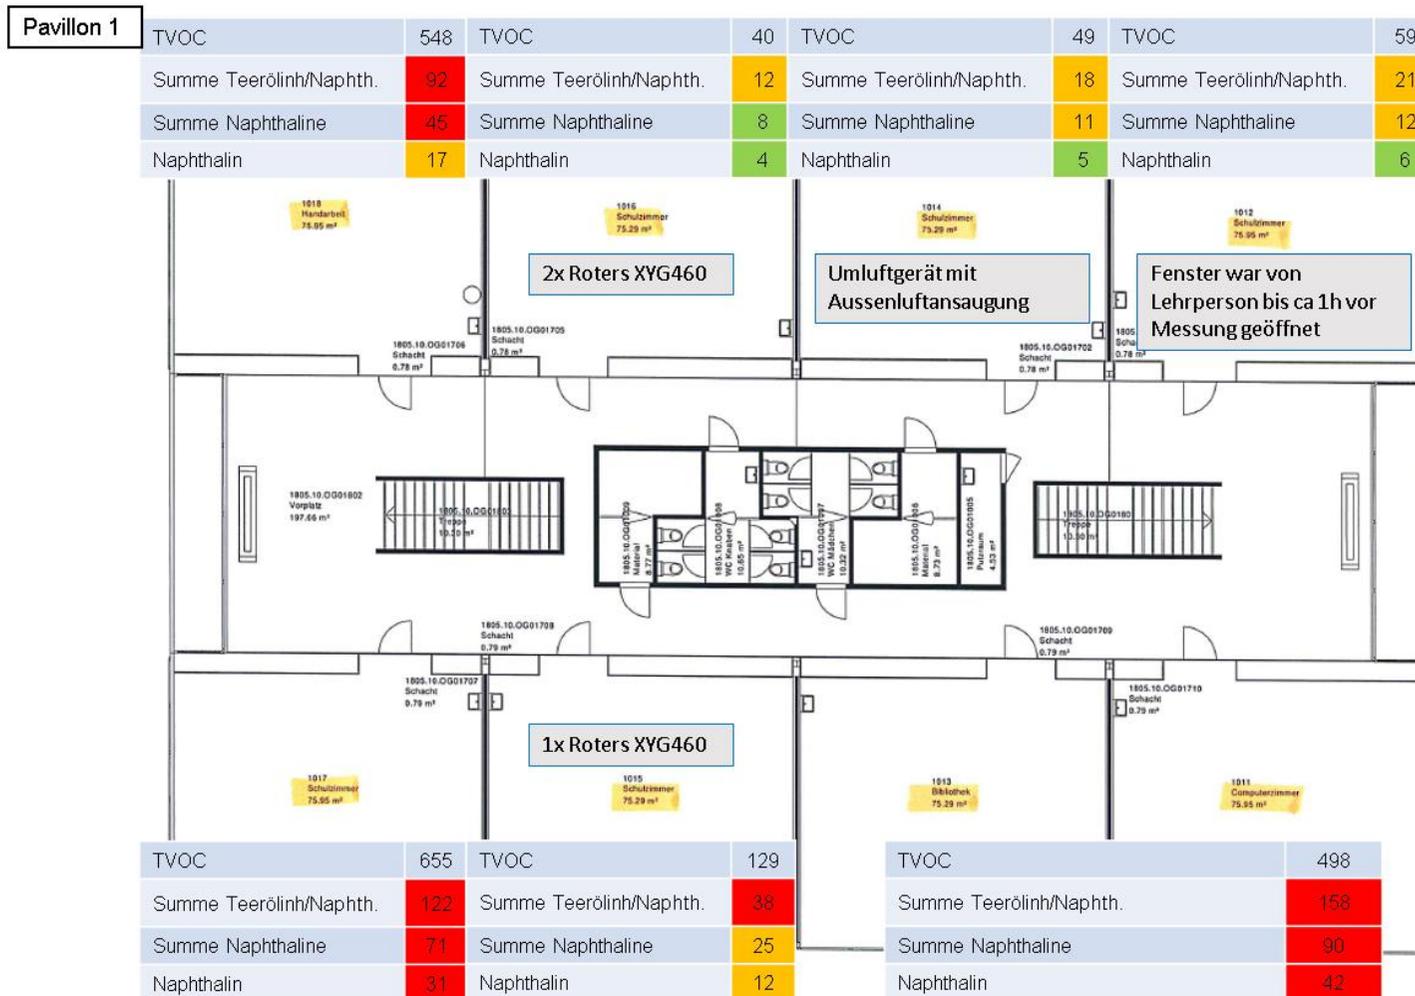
Grundriss 1: Pavillon 1, EG, Resultate Mai 2018
